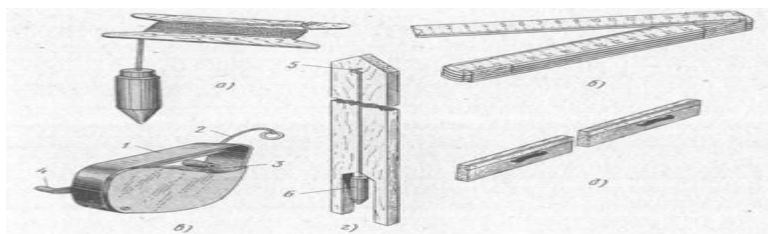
Контрольно-измерительные инструменты и приспособления для провешивания стен: а — отвес, б — складной метр, в — разметочный шнур в корпусе, г — правило с отвесом, д — правило; 1 — корпус, 2 — шнур, 3 — барабан, 4 — ручка, 5 — скоба, 6 — отвес
